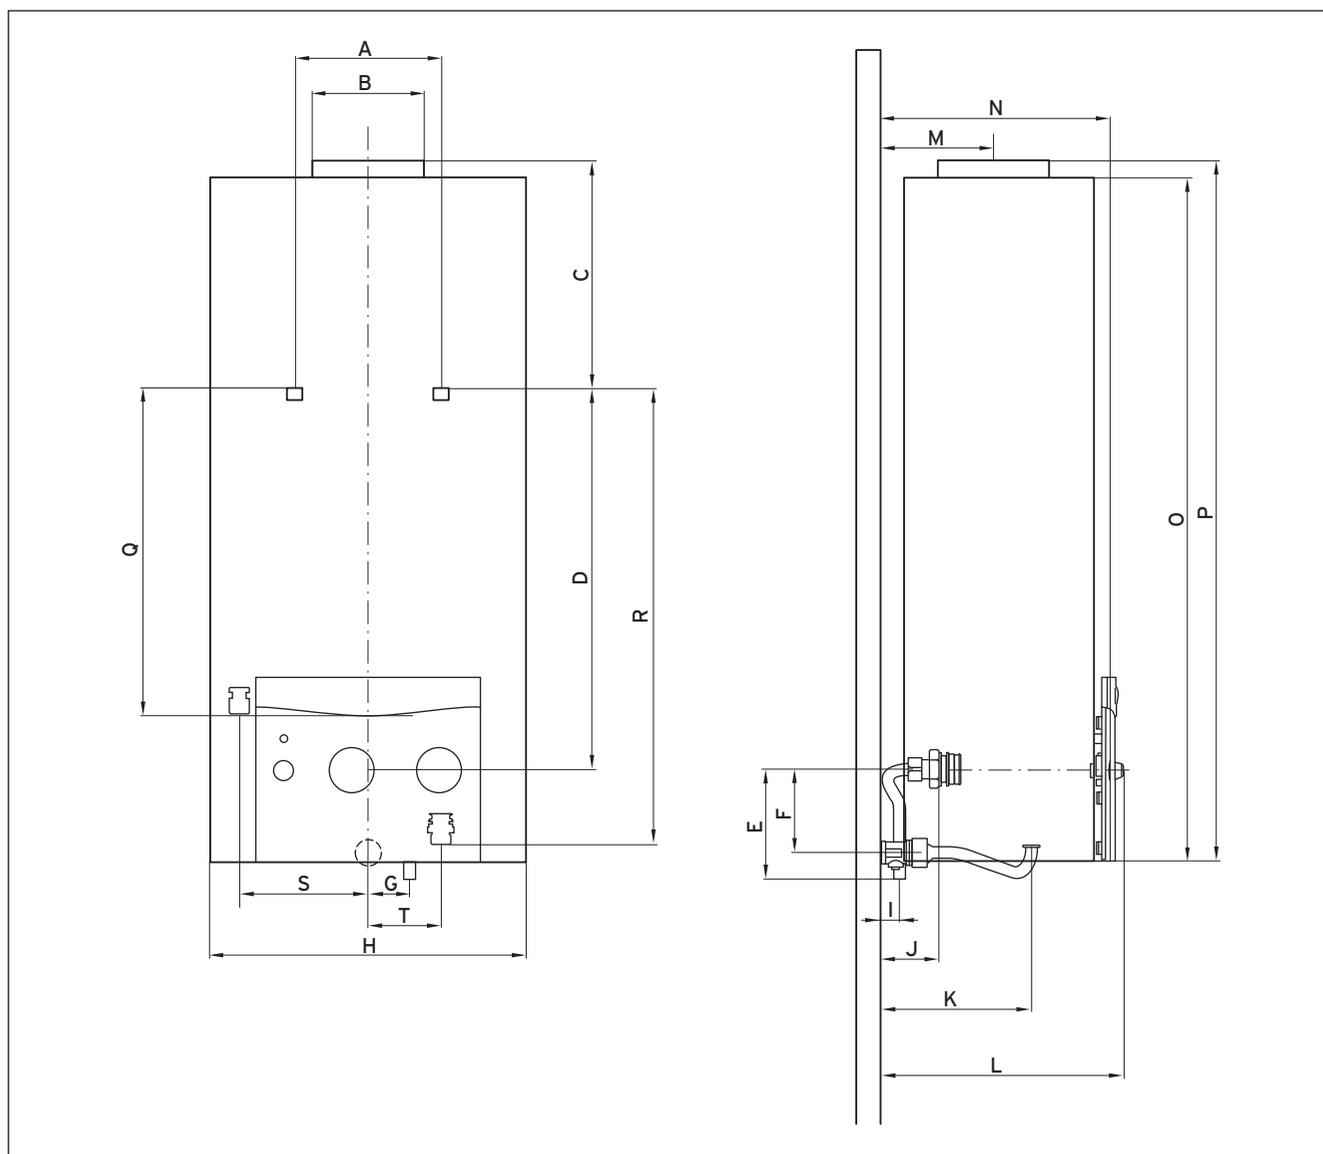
Desenho das dimensões do atmoMAG 6
